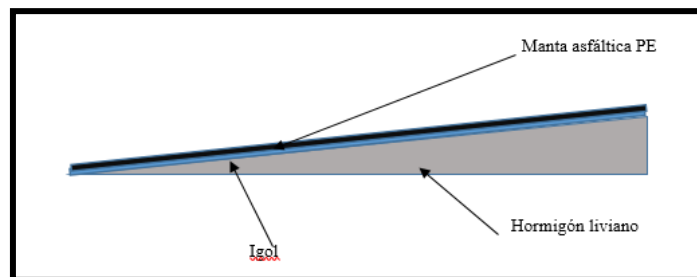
Detalle de la impermeabilización en la azotea.
